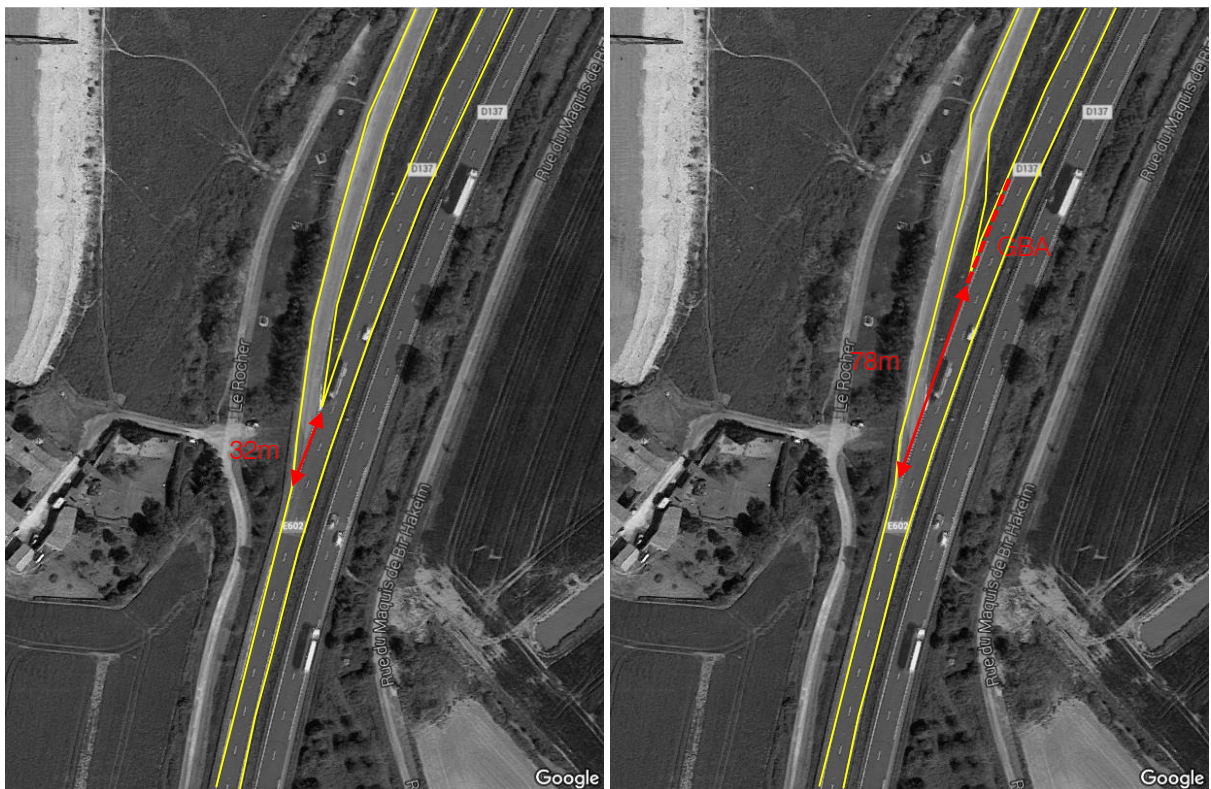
voie d'insertion sur la RD137 : existante (à gauche) / temporaire (à droite)
